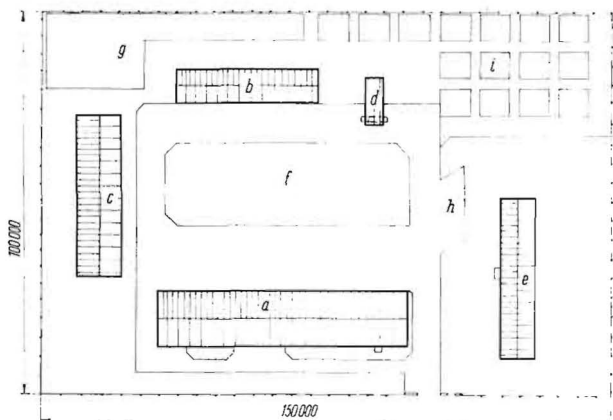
Musterlageplan für eine Außenstelle eines VEB Meliorationsbau. a Betriebswerkstatt mit Fahrzeugwaschhalle, b Garagen für LKW und Traktoren, c Unterstellhalle für Meliorationsmaschinen, d Tankstelle für DK (nicht überall erforderlich), e Verwaltungsgebäude, f Abstellplatz für Anhänger, g Abstellplatz für Maschinen und Geräte, h Lagerplatz für Baumaterial
